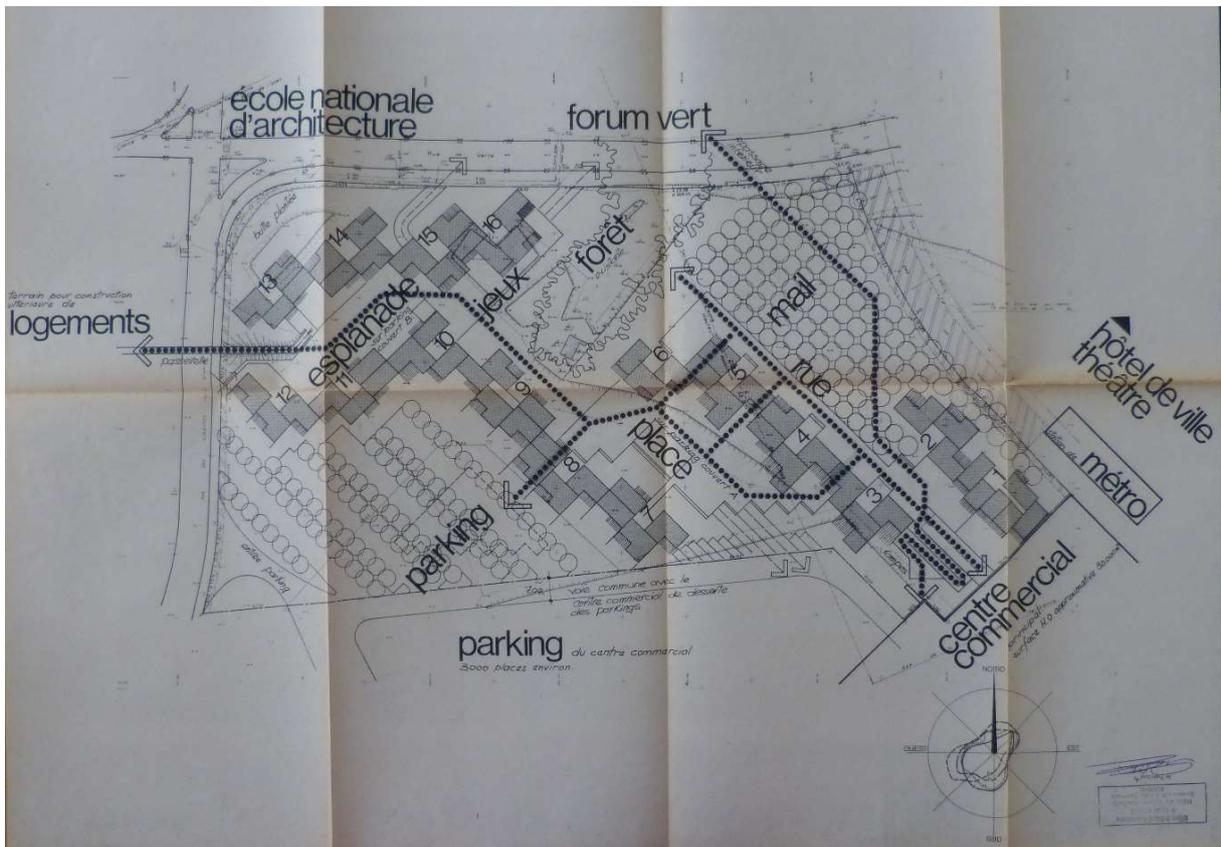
Plan de masse de l'opération. AMVA / Fonds 340W22.
